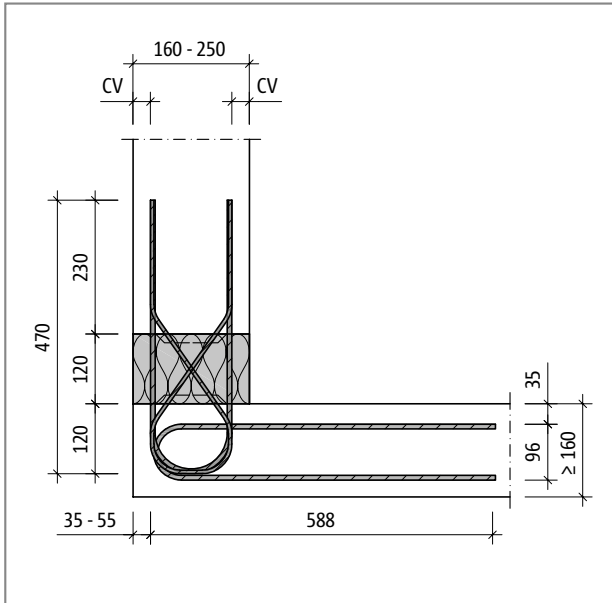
Schöck Isokorb® XT Typ A-MM1: Produktschnitt
